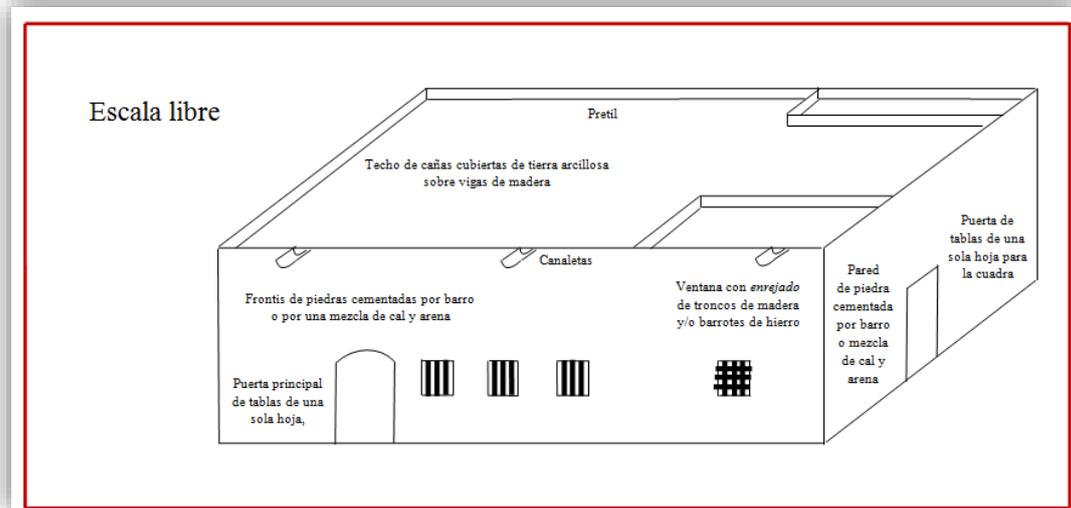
alzado de las fachadas frontal y lateral de un cortijo tipo del Campo de Níjar (Almería).
